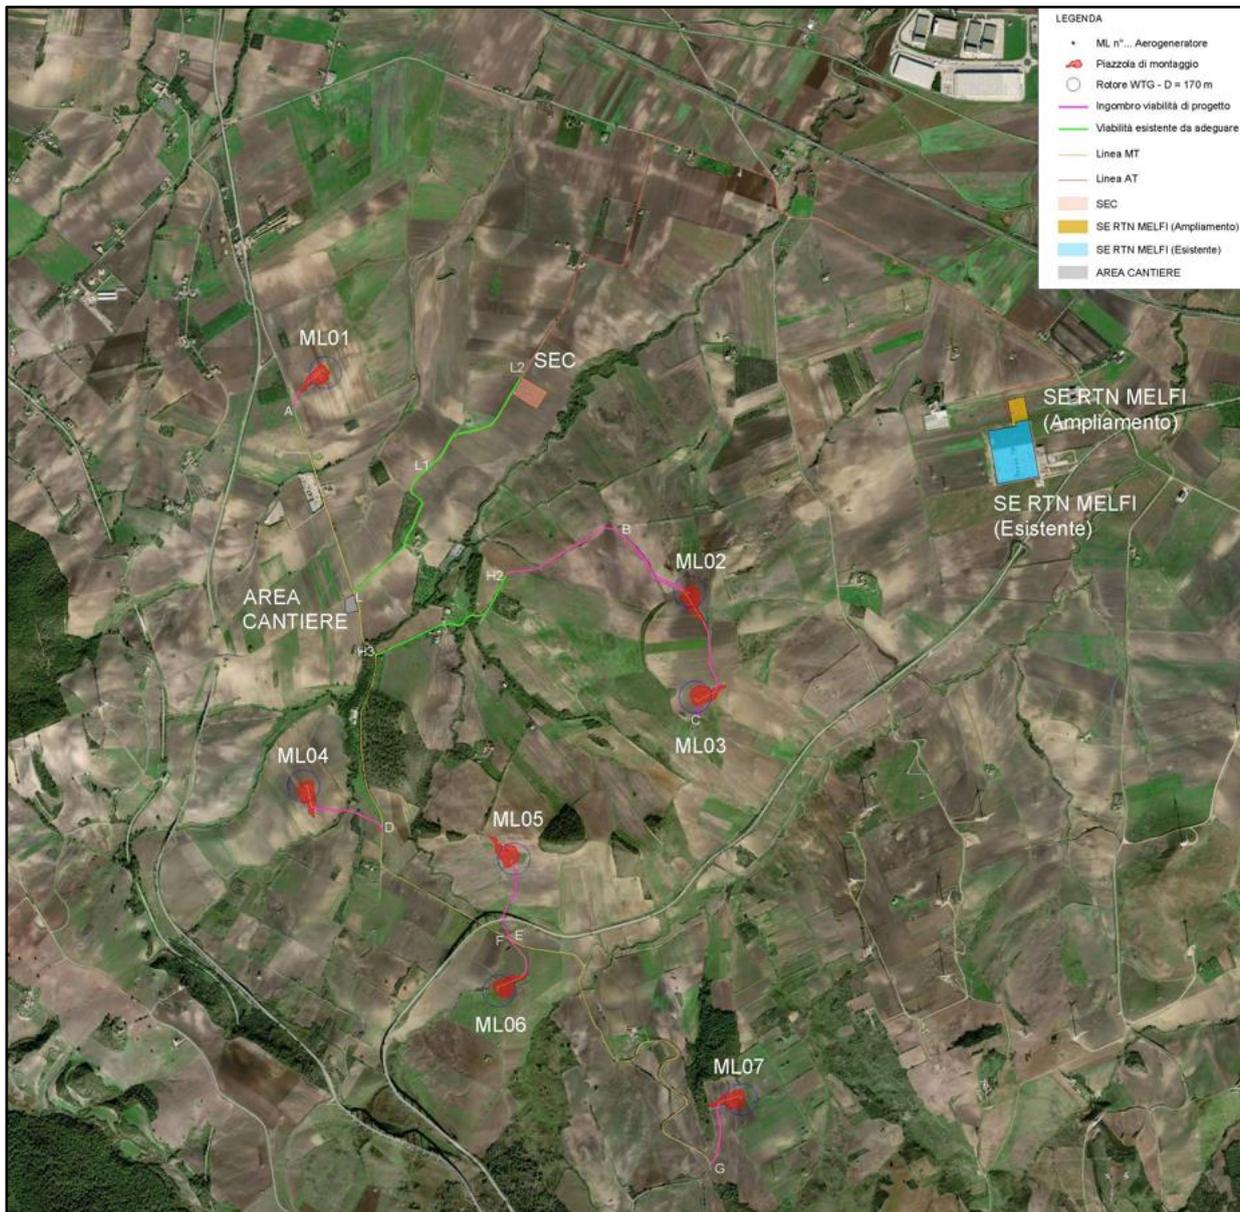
Planimetria viabilità in fase di montaggio
